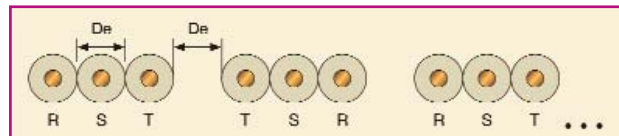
Disposição com os cabos de cada grupo RST posicionados lado a lado
